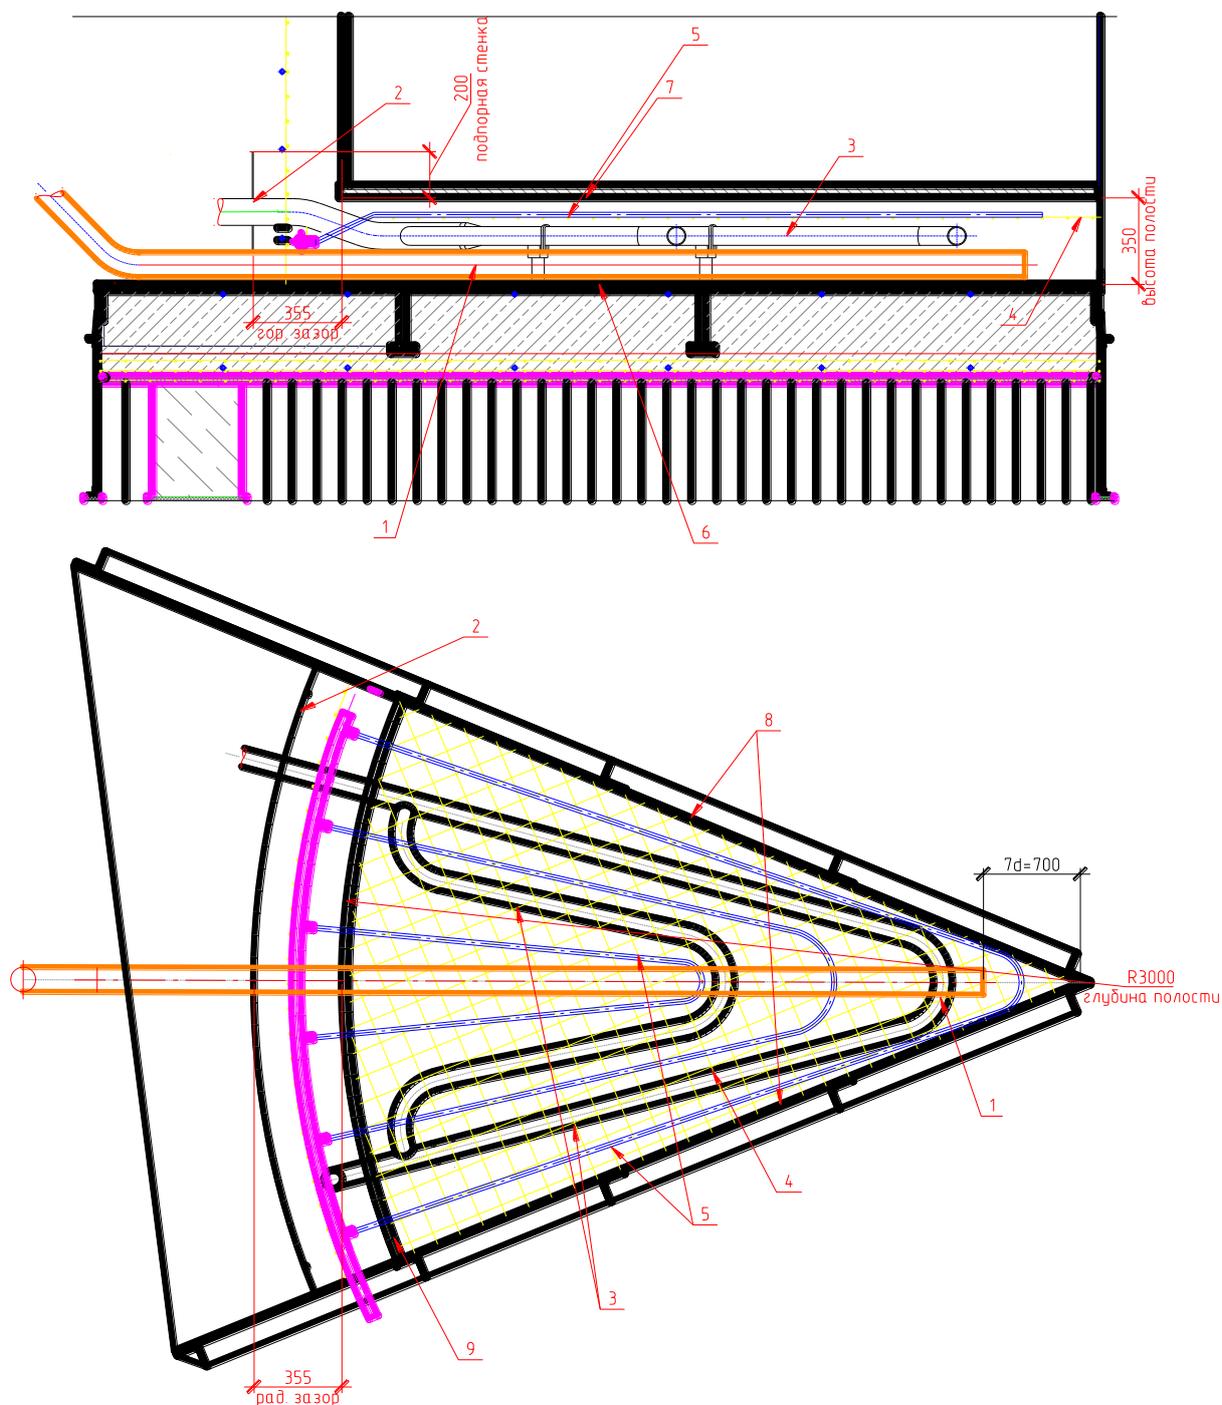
Разрез и план полости натурального эксперимента: 1 – бетоновод; 2 – кольцевая съемная опалубка; 3 – трубопроводы; 4 – арматурная сетка; 5 – гибкие гофрированные трубки; 6 – нижняя металлическая плита; 7 – верхняя металлическая плита; 8 – боковая опалубка; 9 – стенка аппарата.
